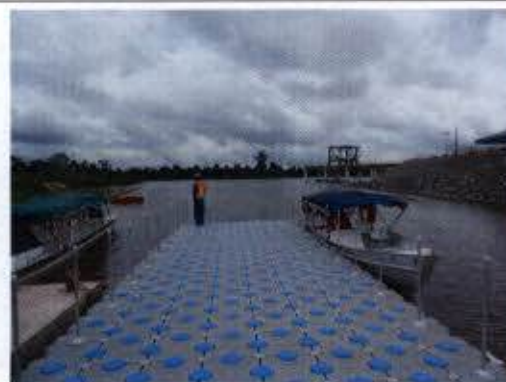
Flutuador da rampa de montante do Sistema de Transposição de Embarcações.
